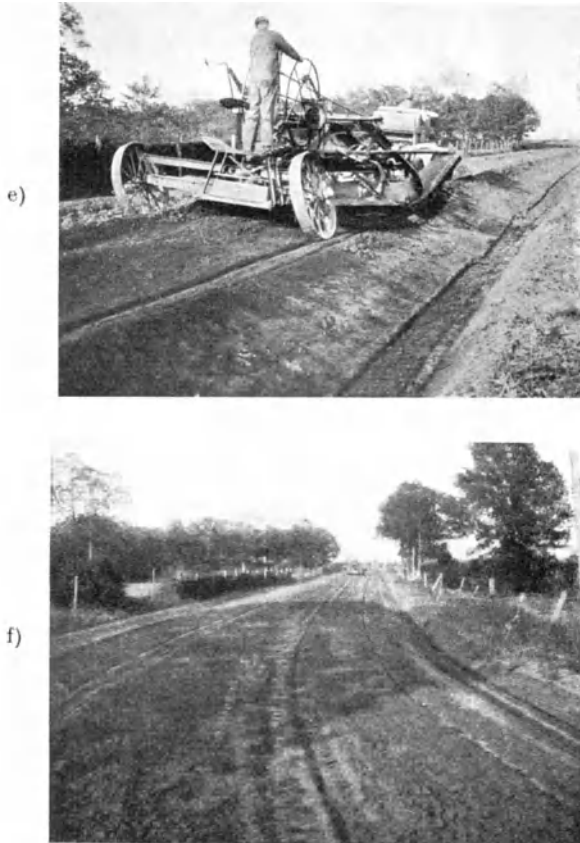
Ansichten der Herstellung des Profiles einer Erdstraße mit Hilfe der Planiermaschine (trapezförmiger Graben) [A 56]. e) Planieren der Fahrbahnfläche, Grabenschaufel bleibt angehängt, um ein Abrutschen loser Erde in den Graben zu verhindern, f) Straße nach der Profilierung.
